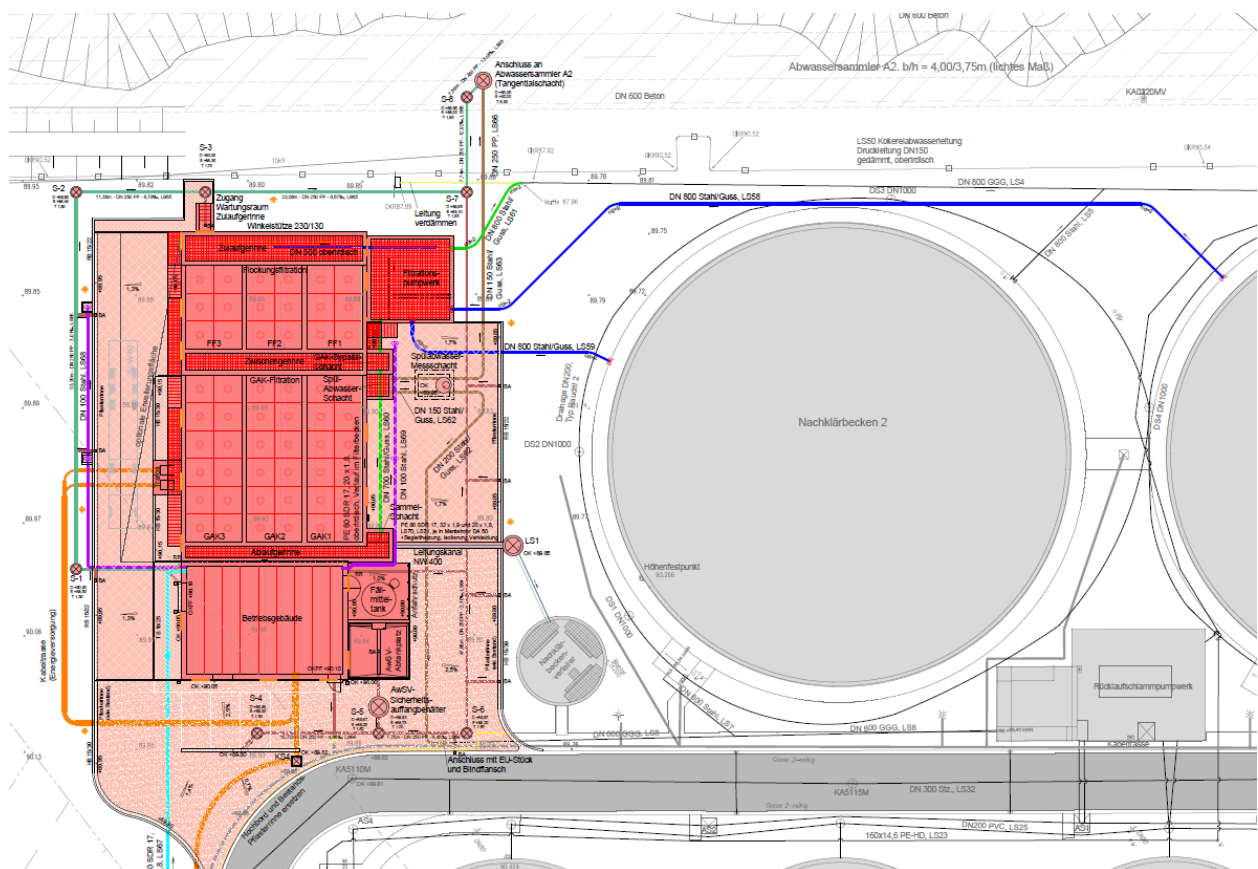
Anbindung und Lage der 4. Reinigungsstufe, Lageplanausschnitt
